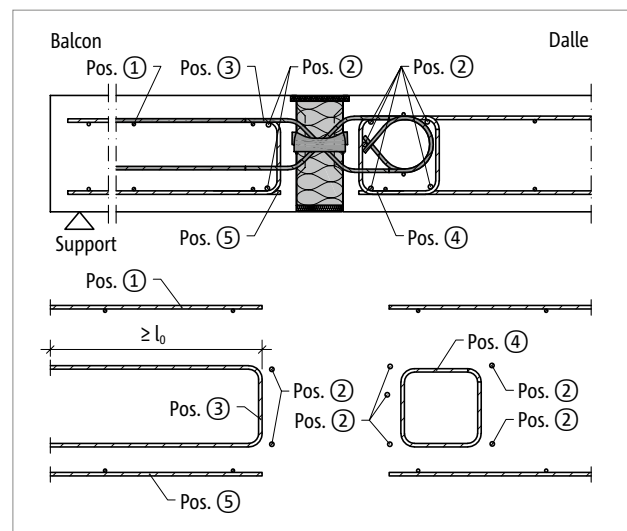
Schöck Isokorb® T Type Q-E-W-VV : Renforcement sur site
